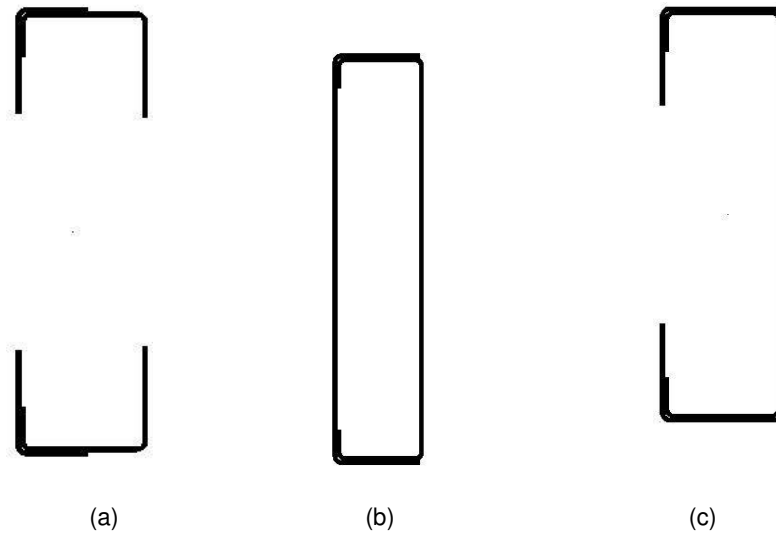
Seção "UC" back to back (a) em compressão. Seção (b) em flexão em torno de y-y (c) em torno de z-z.
